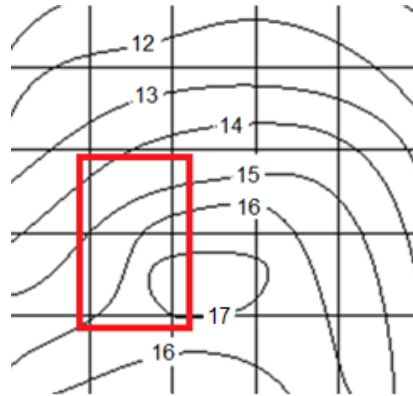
Площадка для застройки Производственный корпус базы автотранспортного предприятия
